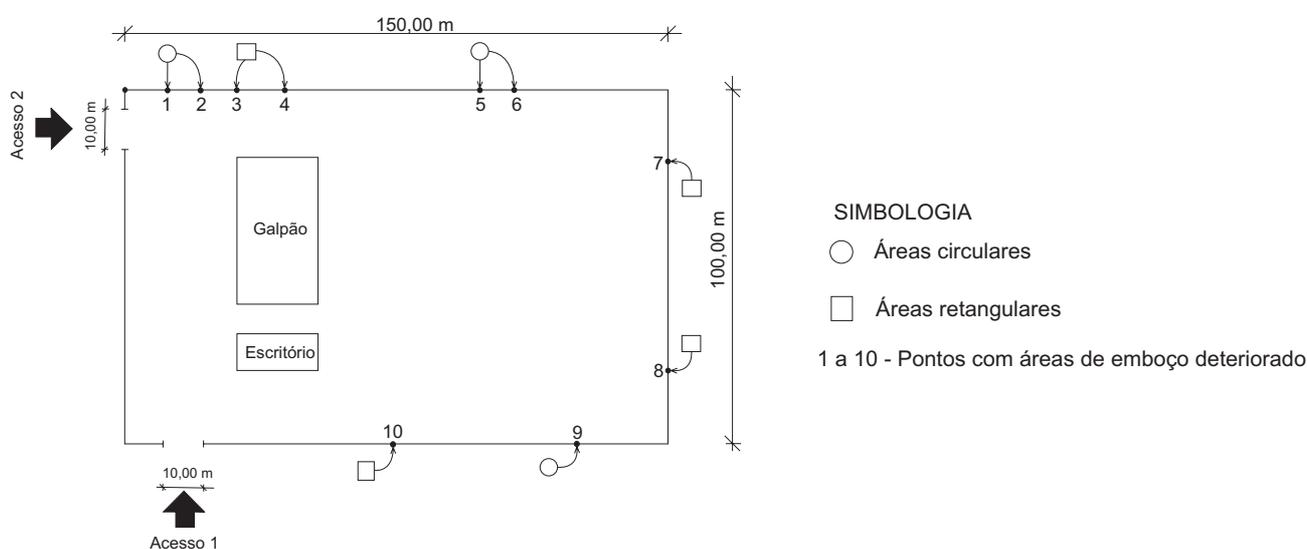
Croqui da planta de situação e indicação dos pontos com emboço comprometido
